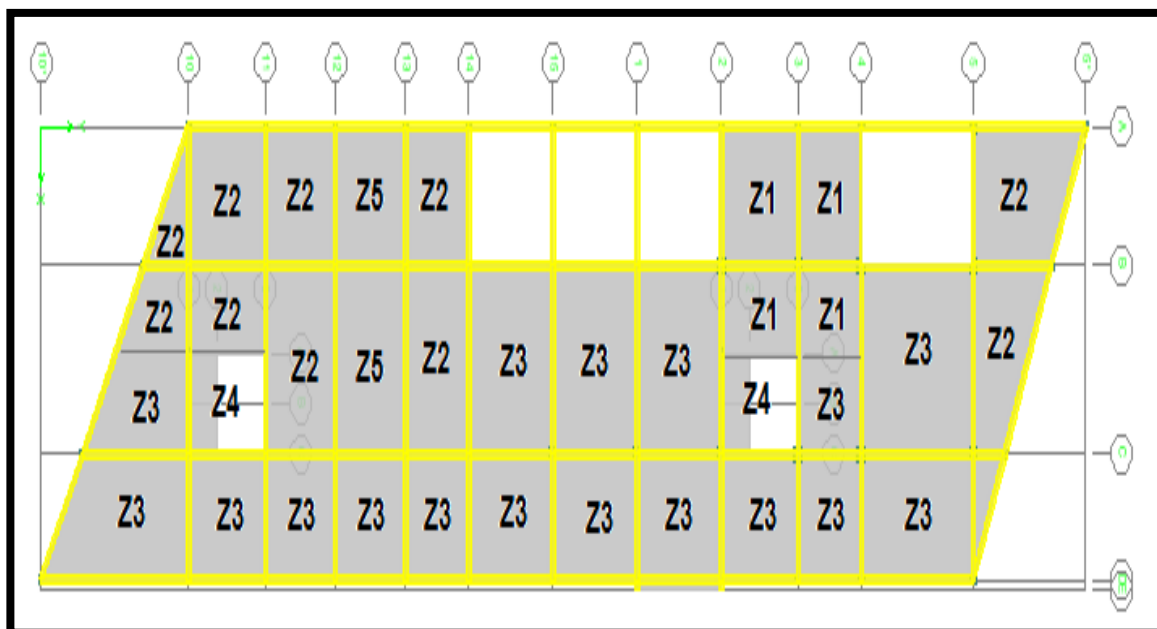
Zonas de la Edificación. Edificio Norte (Nivel 1).
